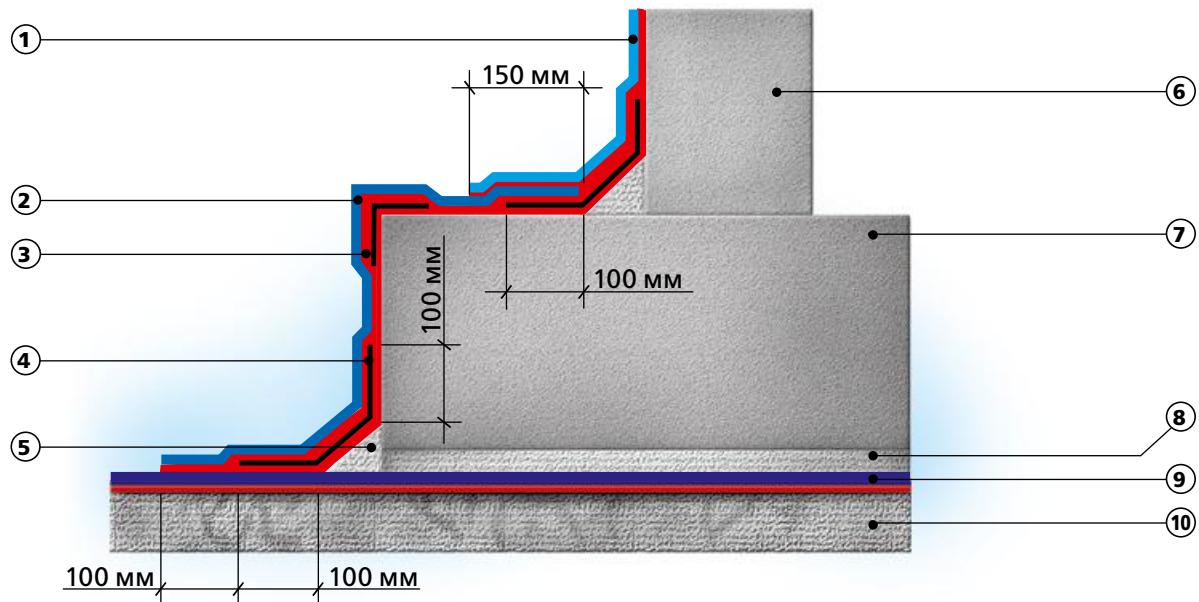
Зона подошвы фундамента. Вариант сплошной приклейки к основанию:
